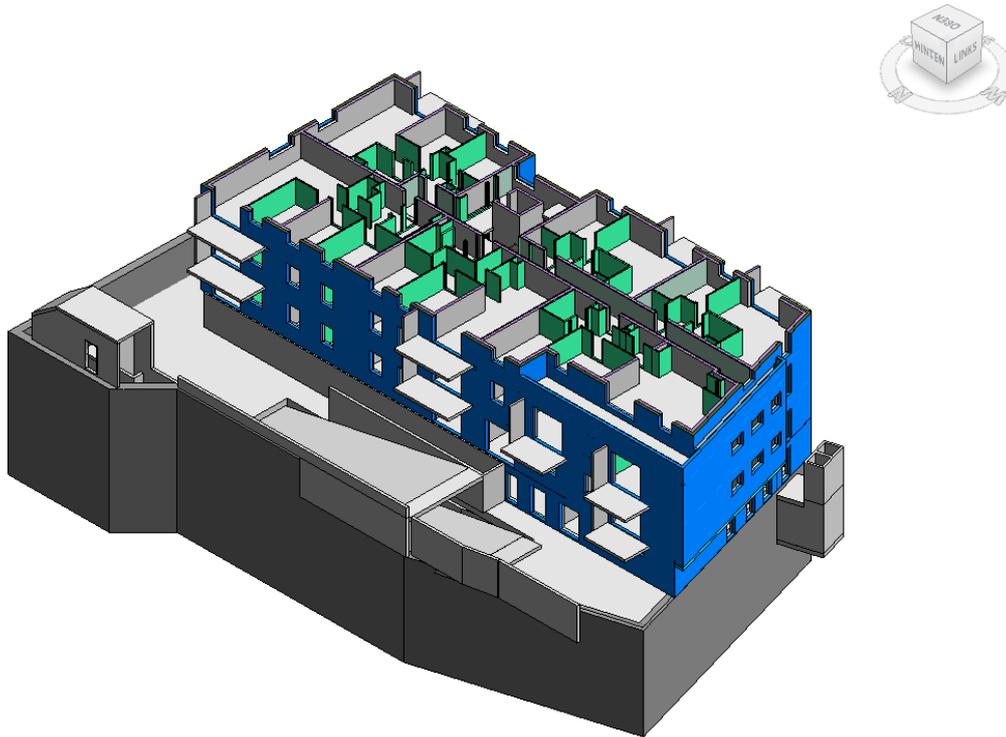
Gebäudeschnitt durch das Dachgeschoss<sup>99</sup>
